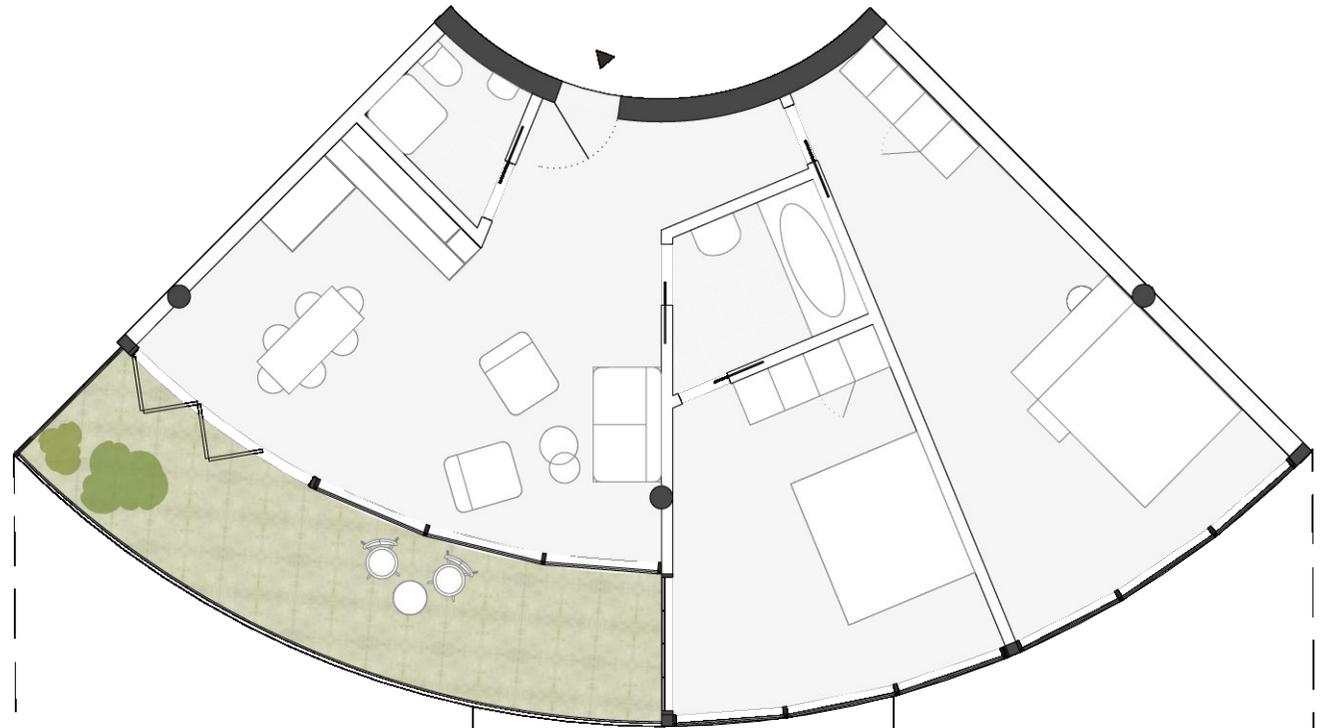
Grundriss Wohnung Typ B
